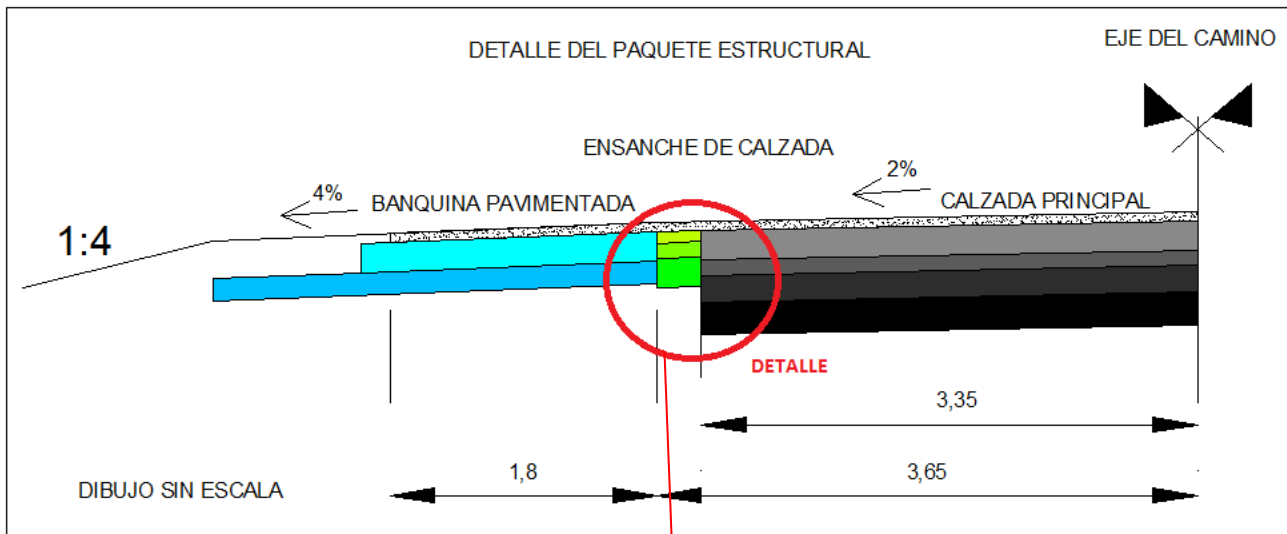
Sección transversal del paquete estructural – Fuente: Elaboración propia
